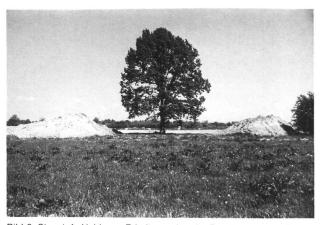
Staustufe Vohburg. Erhaltung einer im Randbereich der Dammstrasse stehenden alten Eiche durch Verlegung der Baustrasse und des Dammfussweges.
